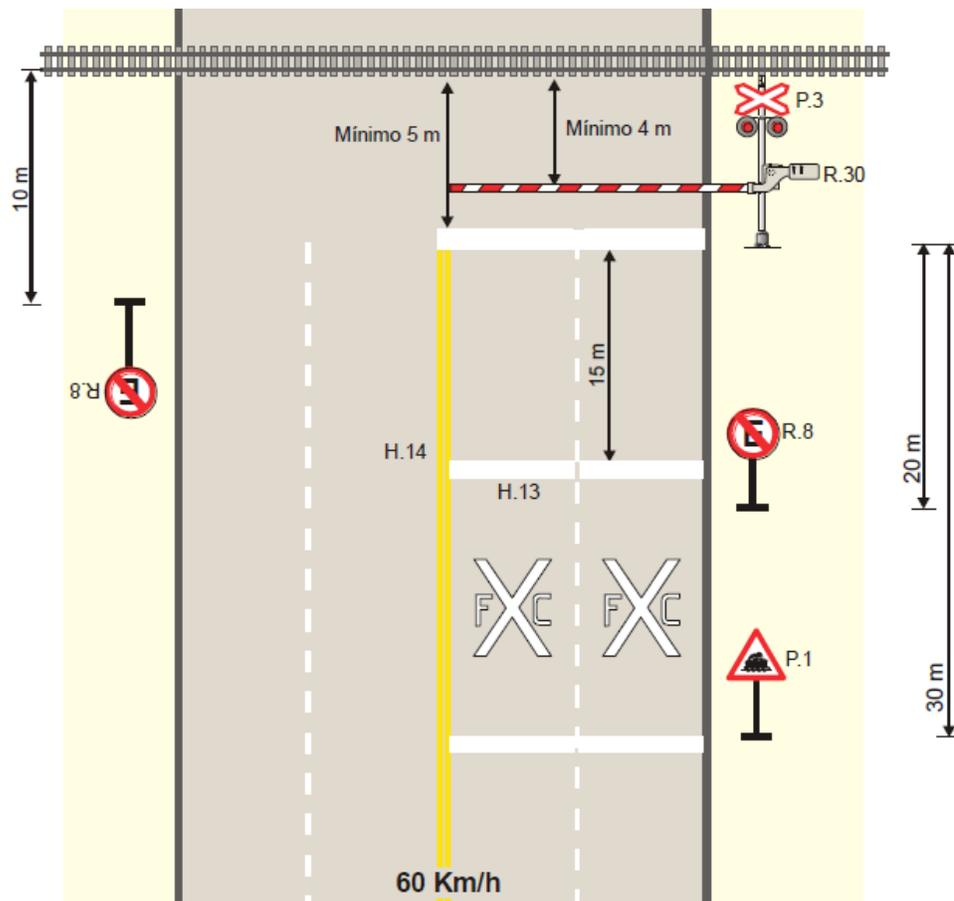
Ejemplo de señalización vial en zona urbana con calzada pavimentada de más de un carril por mano (Avenida) Fuente: Barreras Automáticas – Ing. Horacio Faggiani
